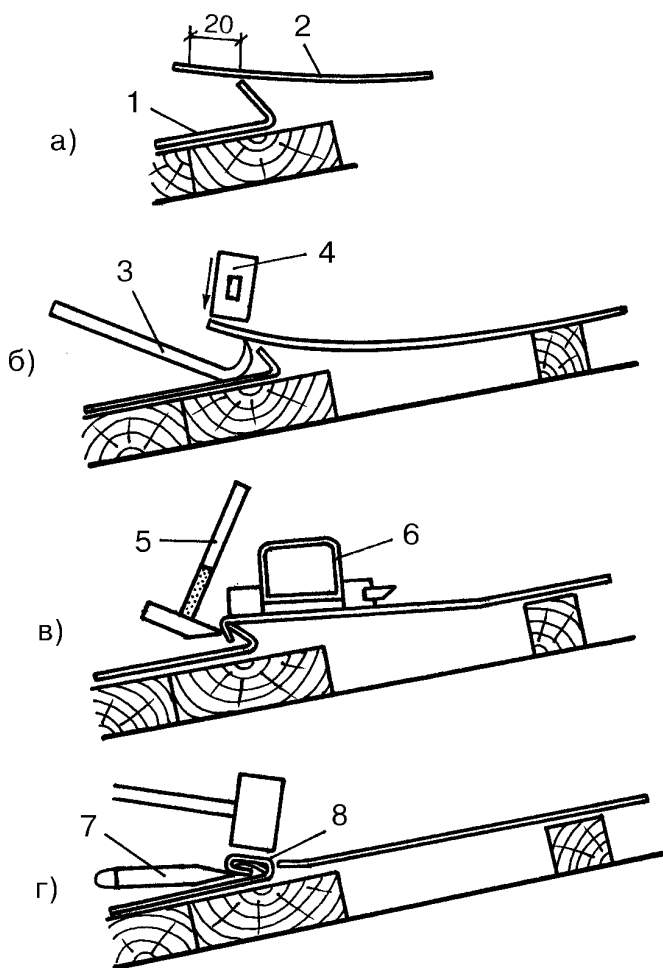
Соединение картин надстенного желоба и рядового покрытия при устройстве кровли
